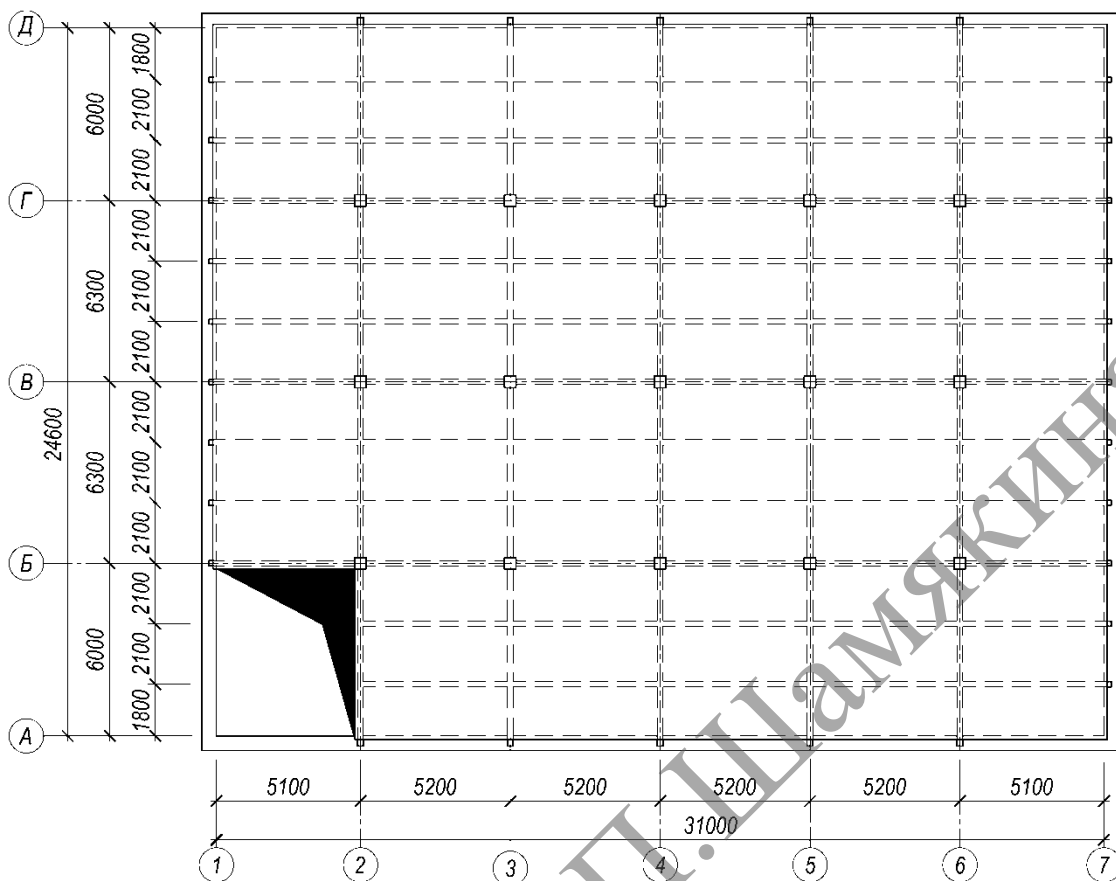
Конструктивная схема перекрытия – вариант 1
